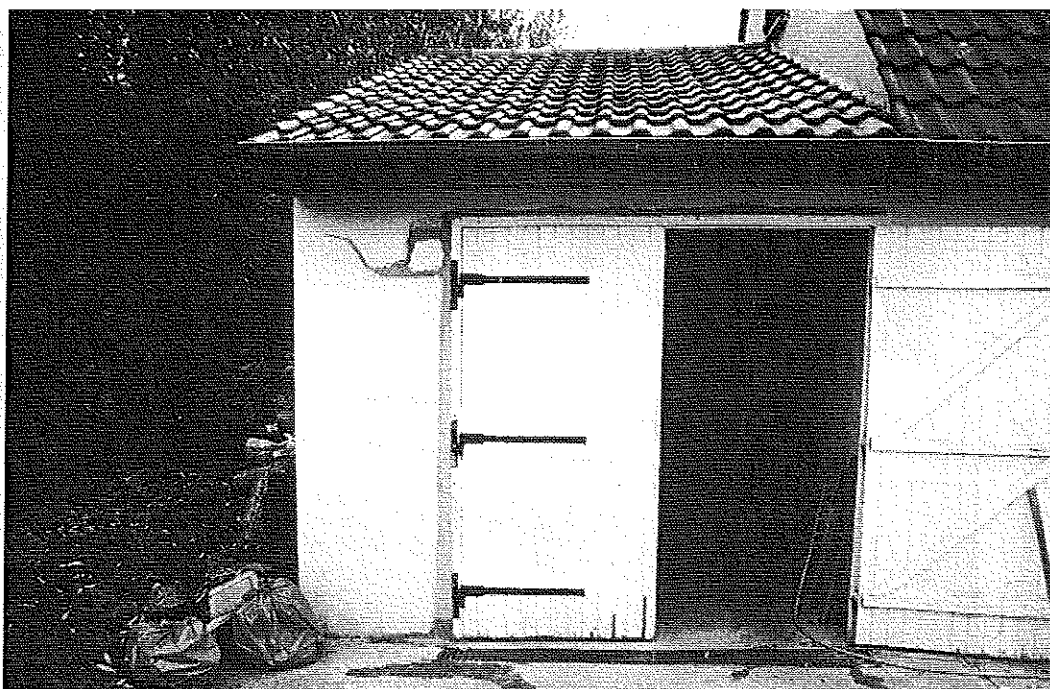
Fissuration appui de linteau + mouvement du tableau. © J. Putatti
